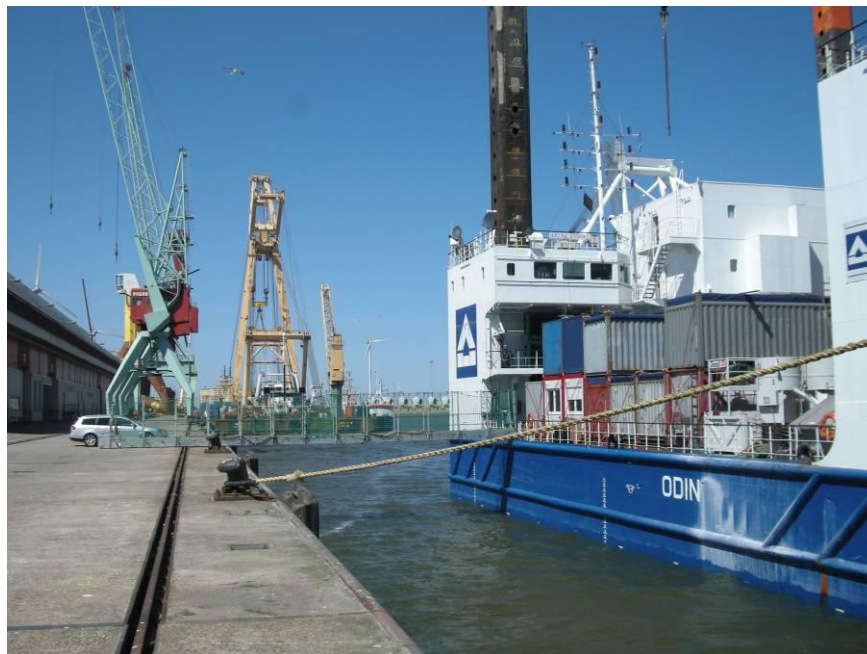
Betriebliche Anforderungen an eine Endmontage- und Verladeeinrichtung : Jack-up Plattformen müssen unmittelbar an der Kaikante „aufjacken“ können.
